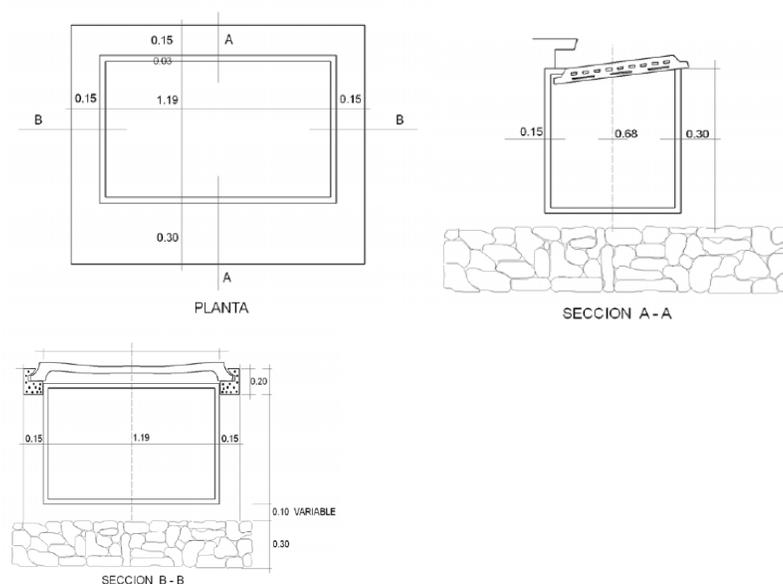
Detalle de pozo de tragante con parrilla de hierro fundido.
